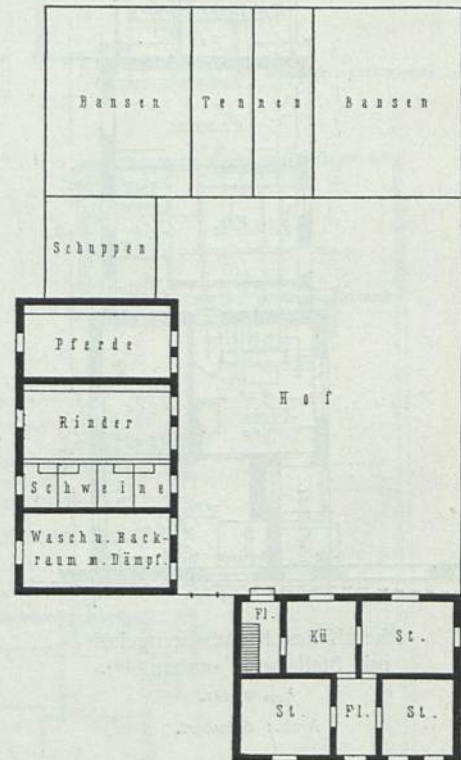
zeigt den Lageplan eines westfälischen An siedelungshofes in Bismarcksfelde für 15^{ha} Grundbesitz. Das Wohnhaus und das quadratische Stallgebäude, in dem Rinder, Pferde und Schweine ohne Trennungswände untergebracht sind, hängen durch einen mit dem Hof in Verbindung stehenden kleinen Flur zusammen. Die große Scheune hat eine Quertenne und am oberen
